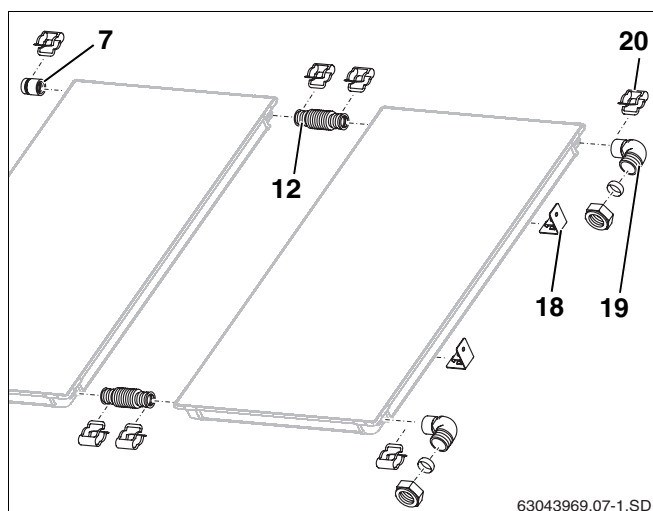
Kollektorfühler und Anschlussstücke montieren
